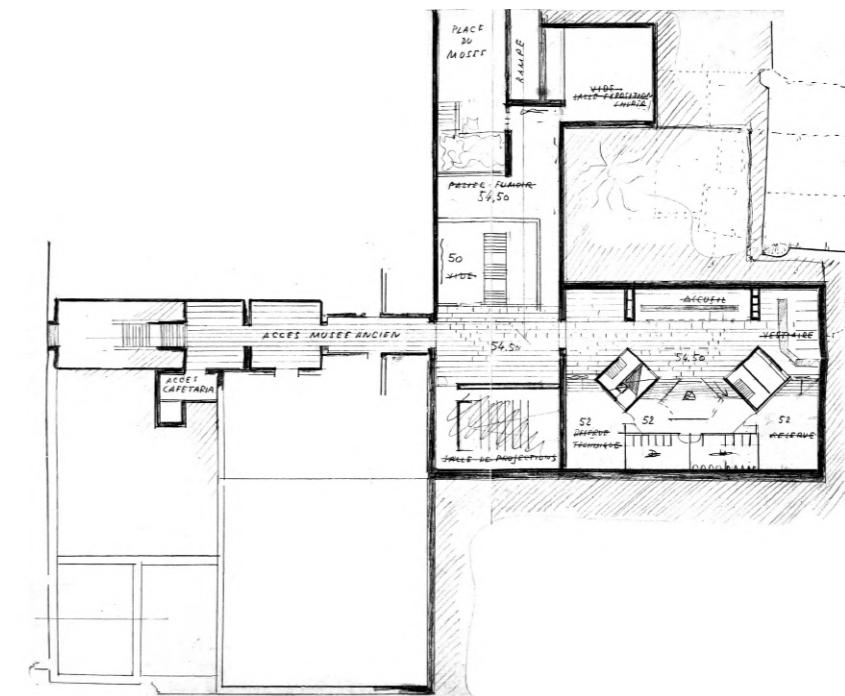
Plan du niveau de l'accueil, ébauche du musée camouflé.
